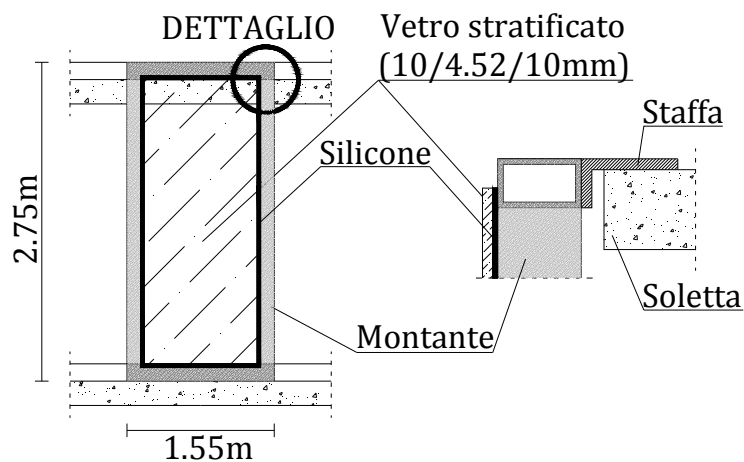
Modulo di una facciata a pannelli e schema di connessione alla struttura retrostante (sezione).
